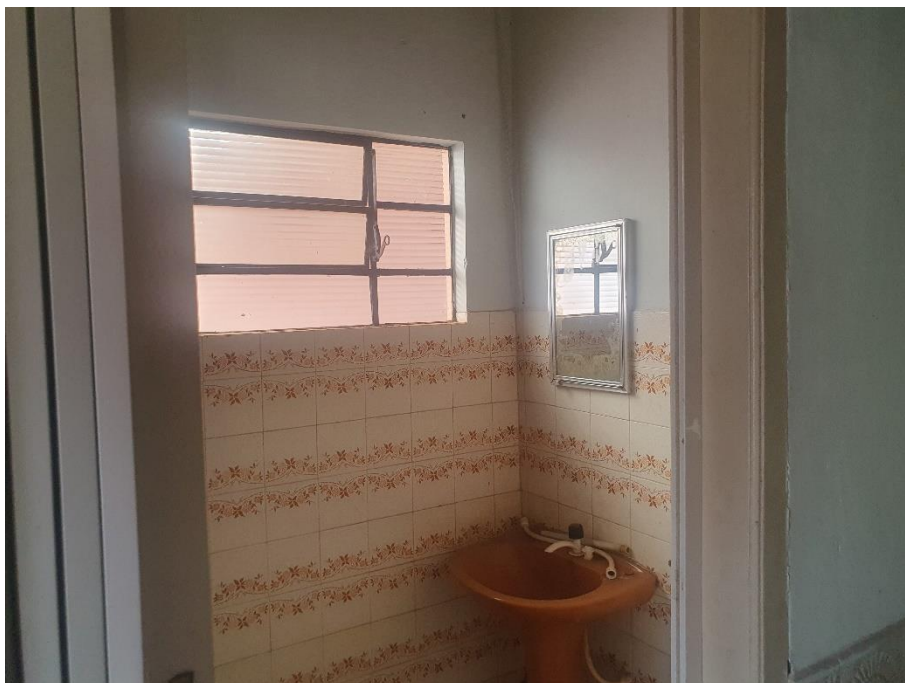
/437 – Banheiro - contendo piso cerâmico vermelho, paredes azulejadas à meia altura restante das paredes rebocadas contendo vaso sanitário e pia.
